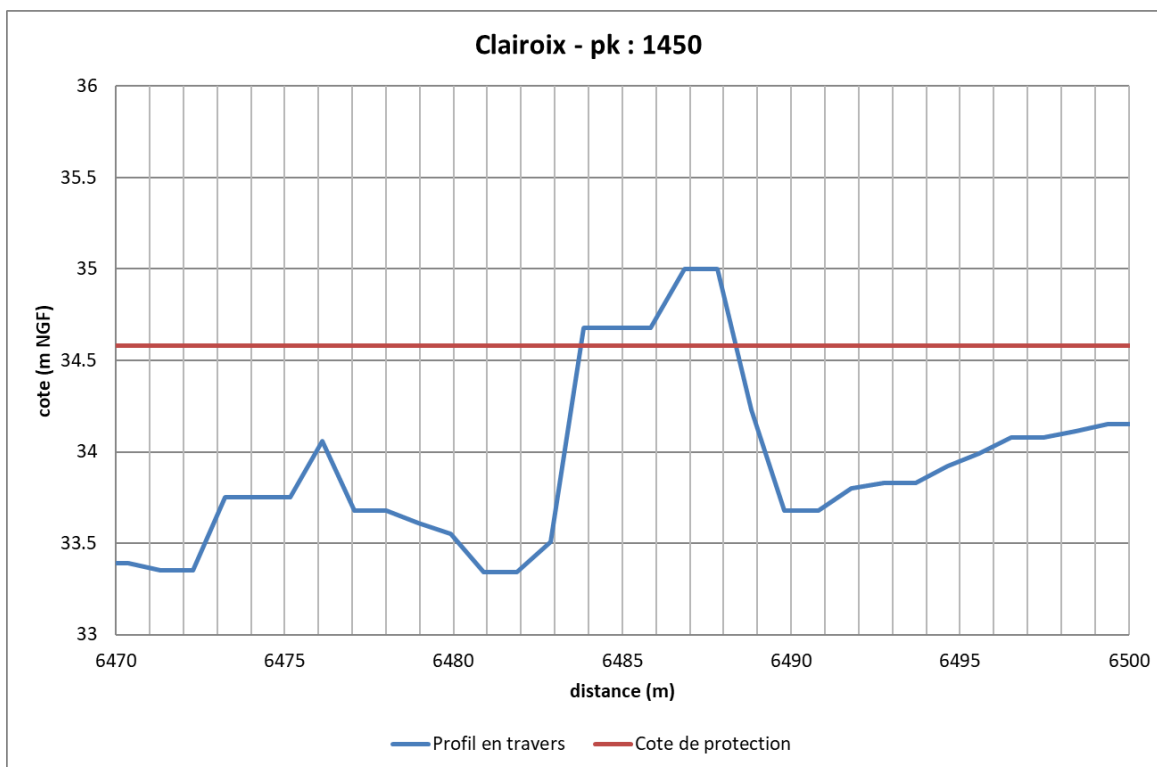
Profil en travers du tronçon 5 du système d'endiguement de Clairoix (partie en remblai)
